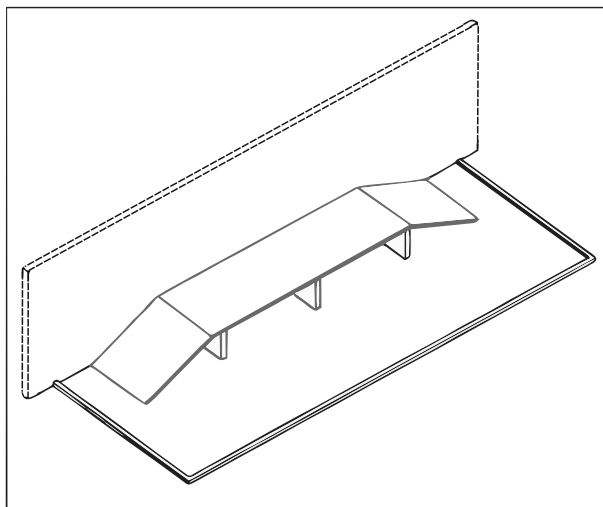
Exemplo de implantação de um plataforma de ordenha.
